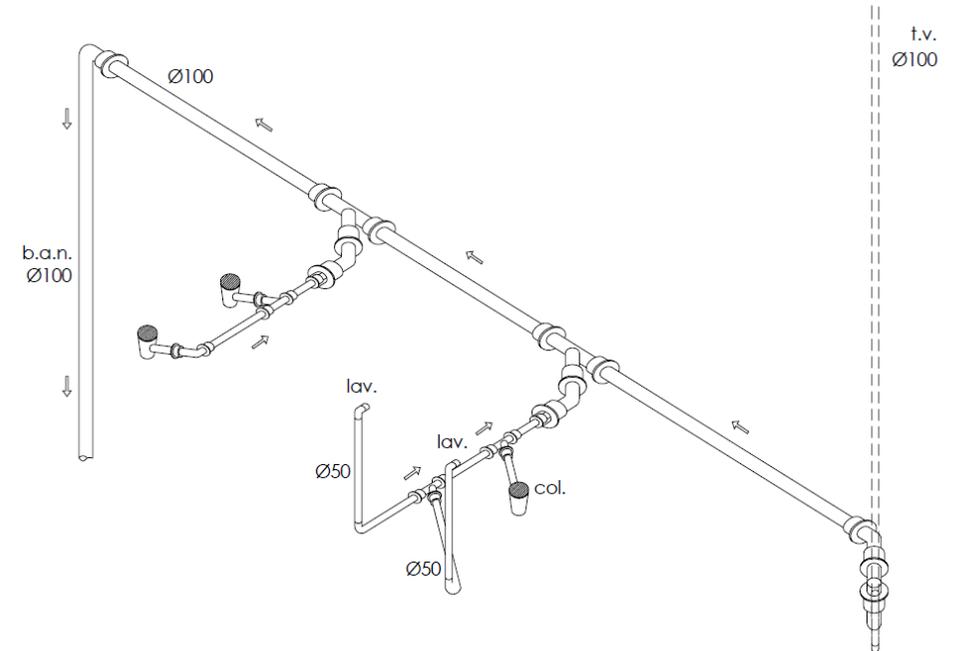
Ejemplo de conexión entre muebles de baño, tubo de ventilación y bajada de aguas negras. Fuente: Ptolomeo UNAM.
